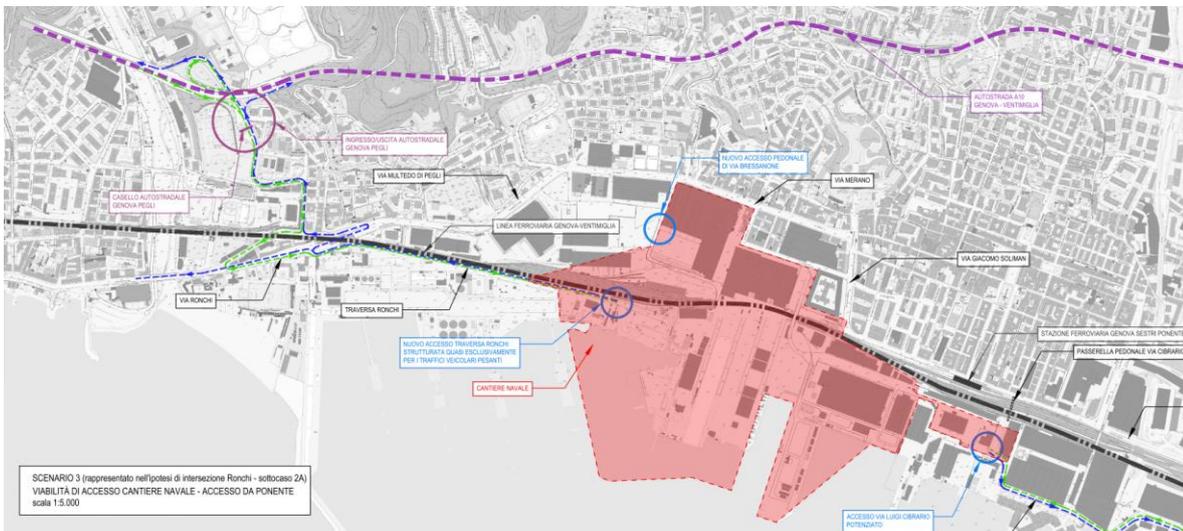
Area cantieristica - organizzazione delle aree allo stato di progetto
